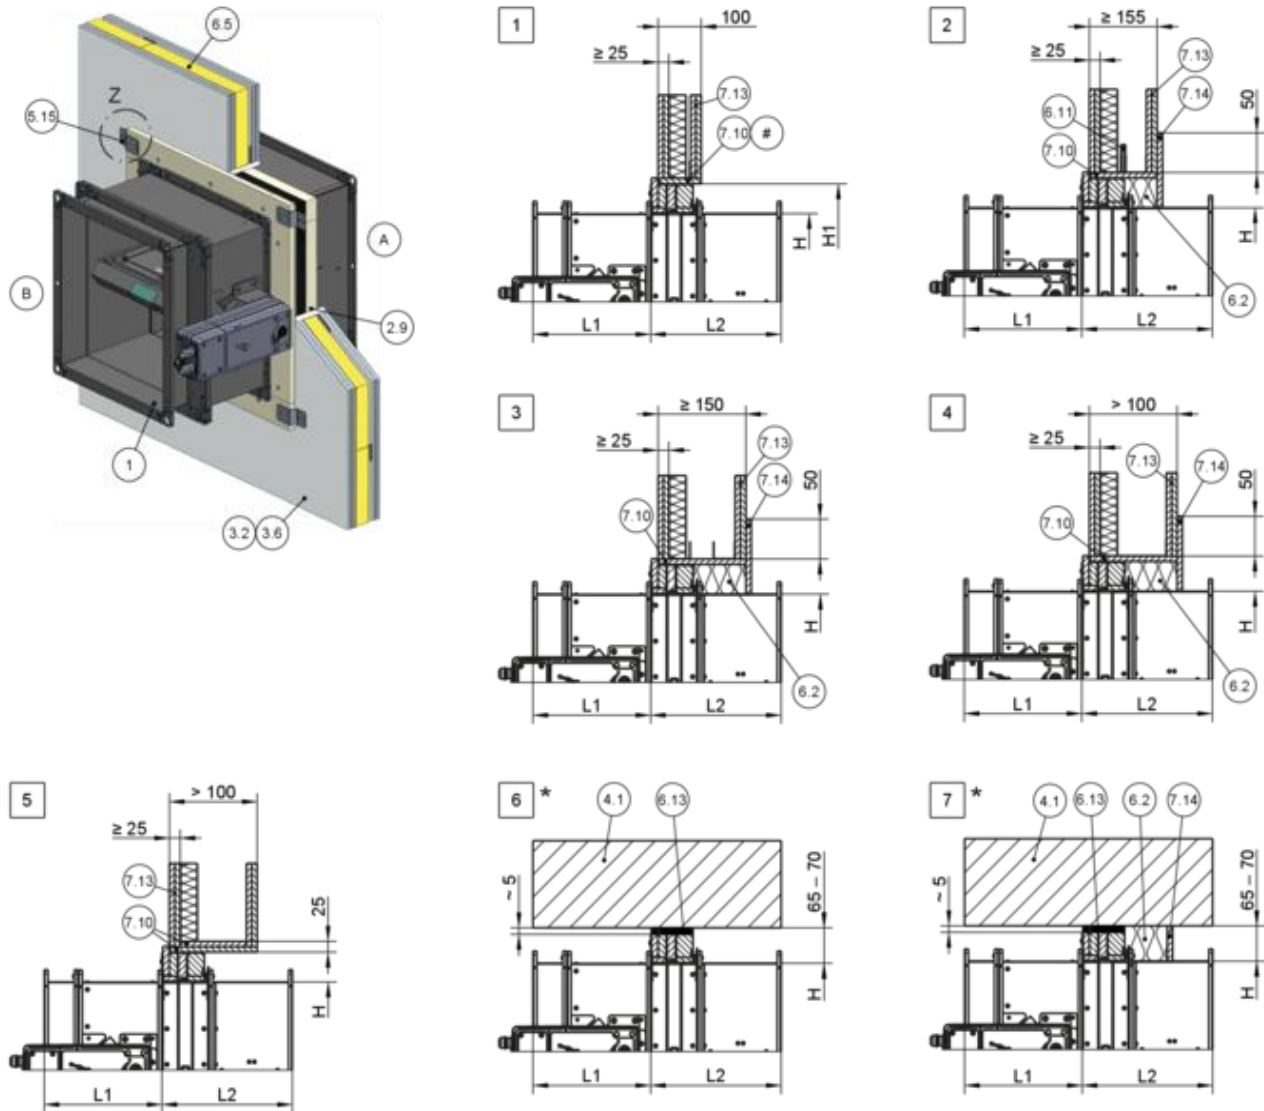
Trockeneinbau mit Einbausatz KES in Leichtbauwand
